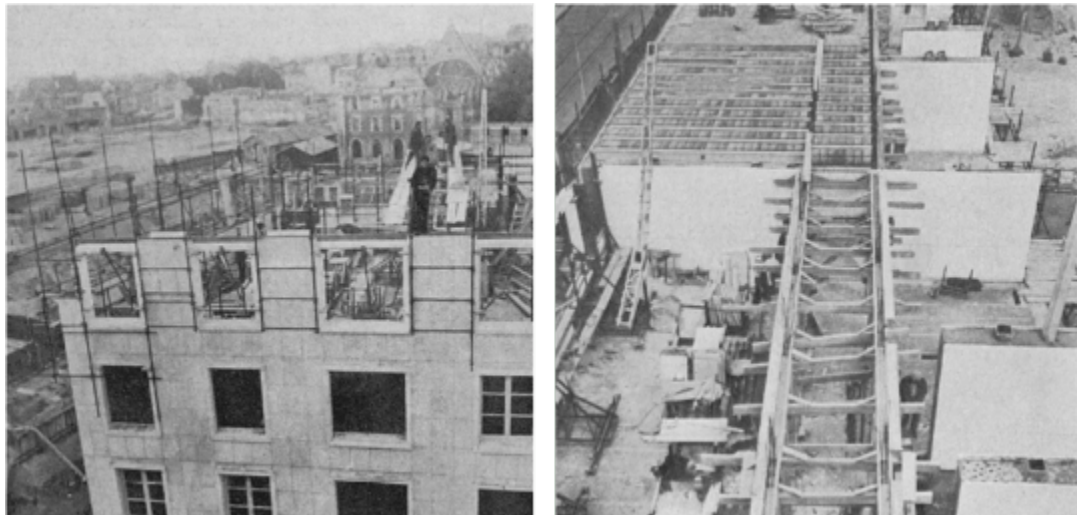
Vues sur la façade principale et le plancher en cours de construction [31].
